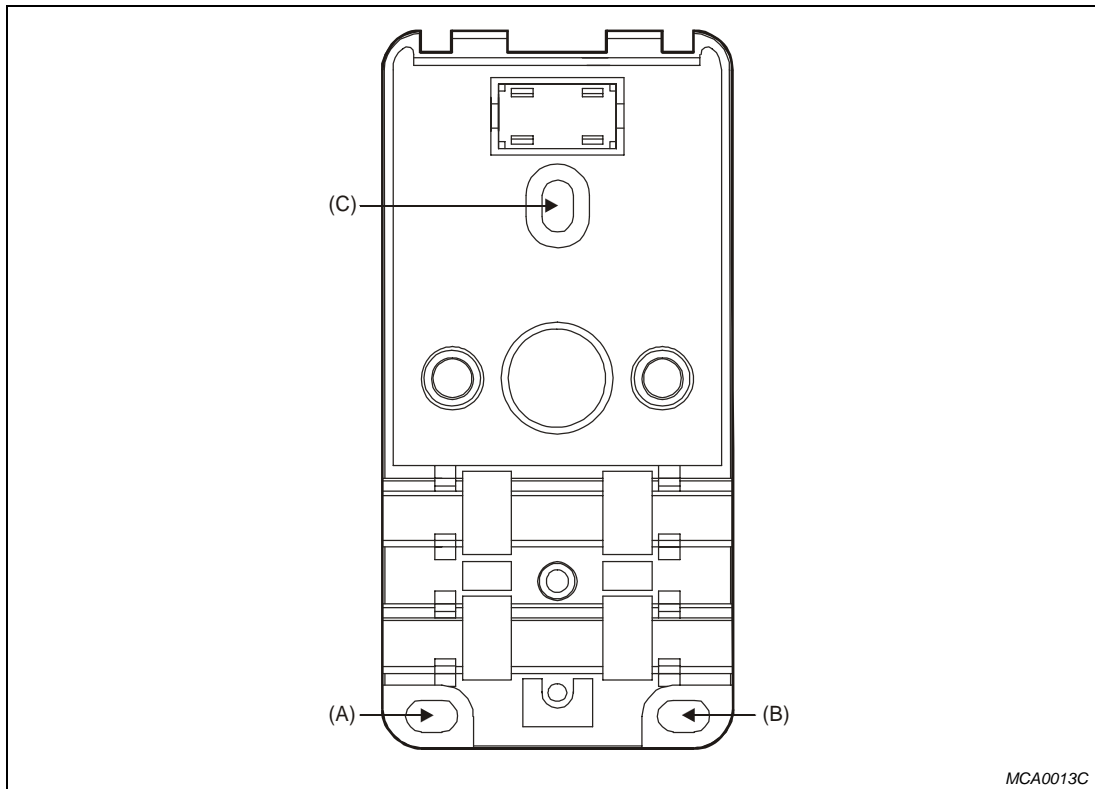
Montageplatte mit Befestigungsbohrungen (A, B, C) zur Modulmontage
